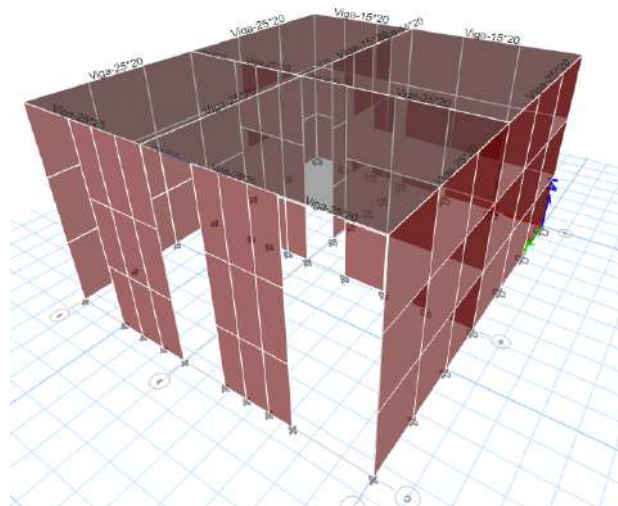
Vista en planta del modelamiento de la vivienda 04
